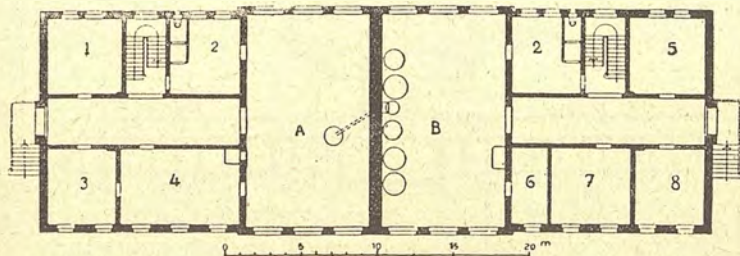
Pianta delle cucine nella prigione di Fuhlsbüttel.
